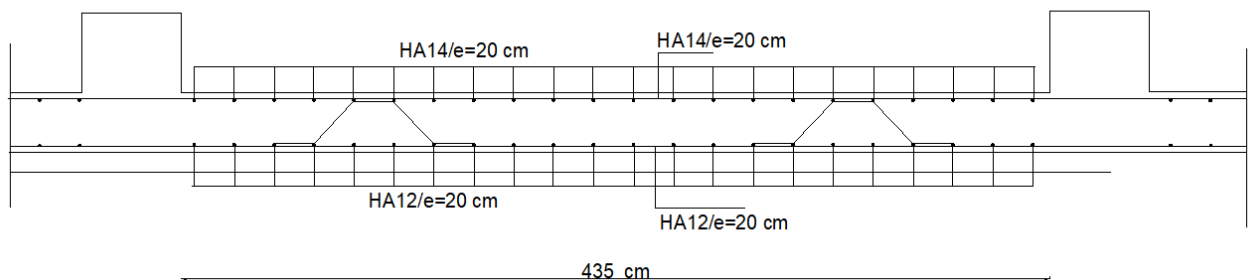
Schéma de ferrailage de la Dalle du radier.
